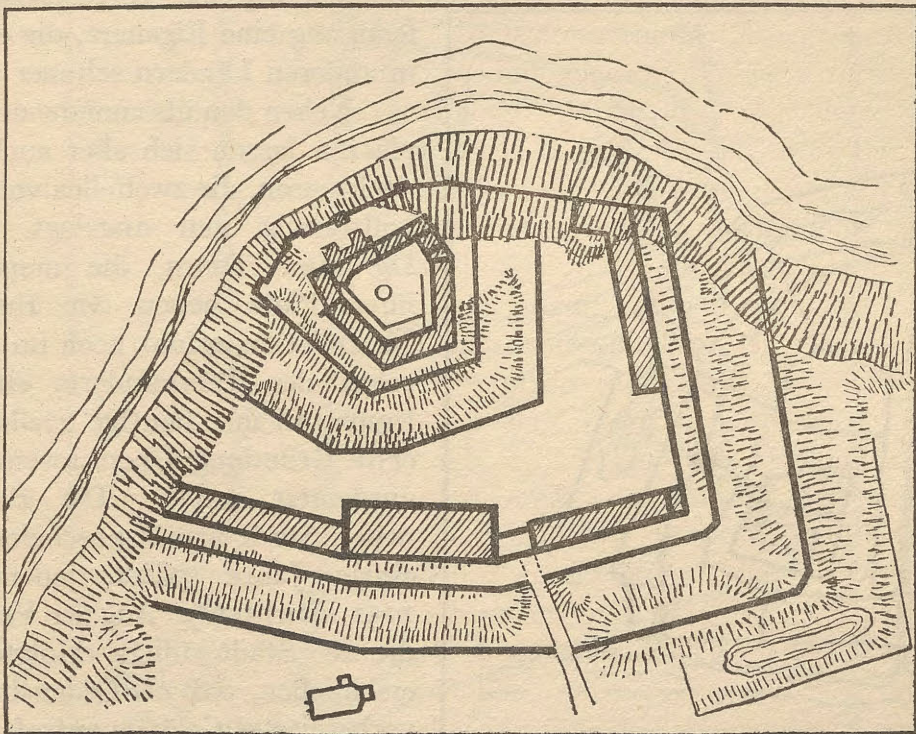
Burg Balga. Lageplan nach Steinbrecht.
